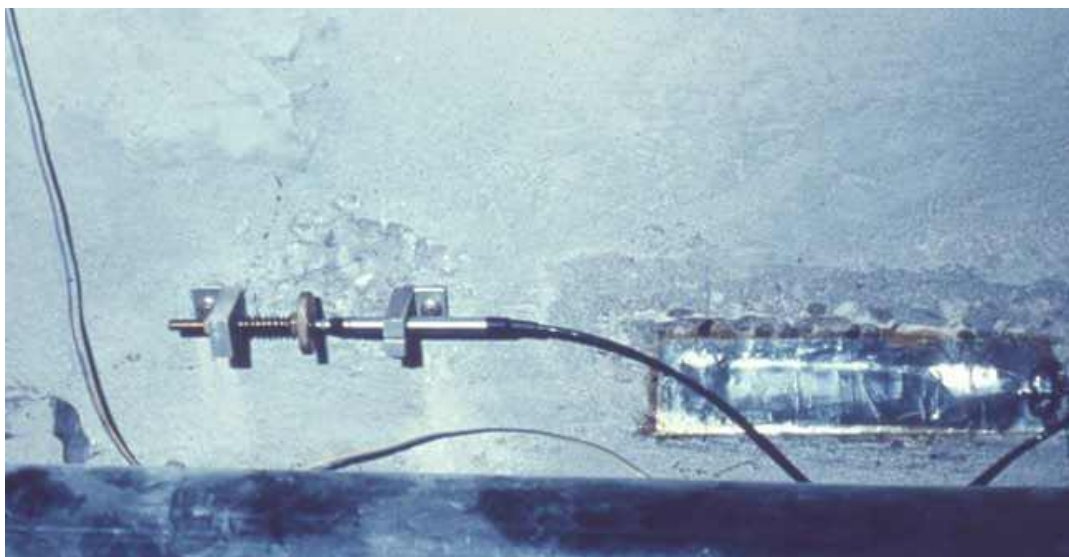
à gauche de l'image, se trouve un capteur de déplacement et à droite une jauge de déformation (crédit photo D. Poineau)
